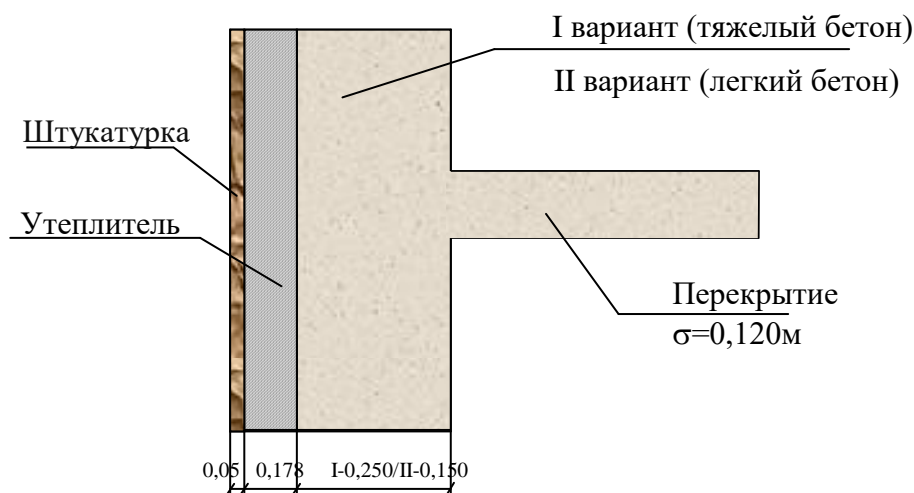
Расчетная конструктивная схема наружной стены и перекрытия.
